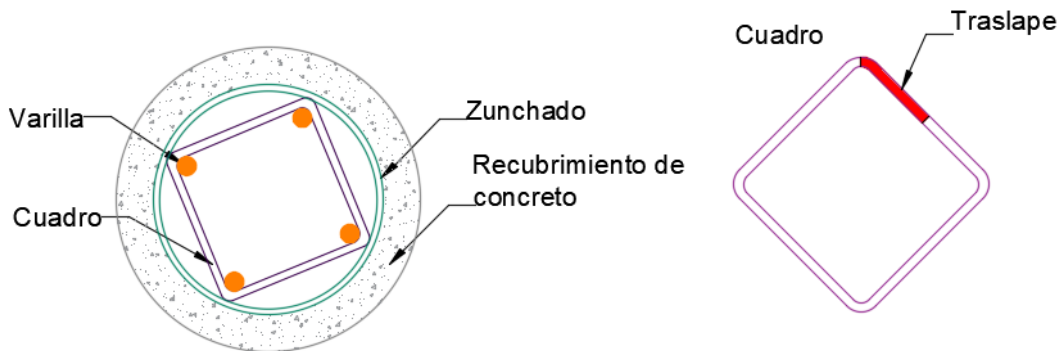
Cuadro en corte transversal en el poste de concreto.
